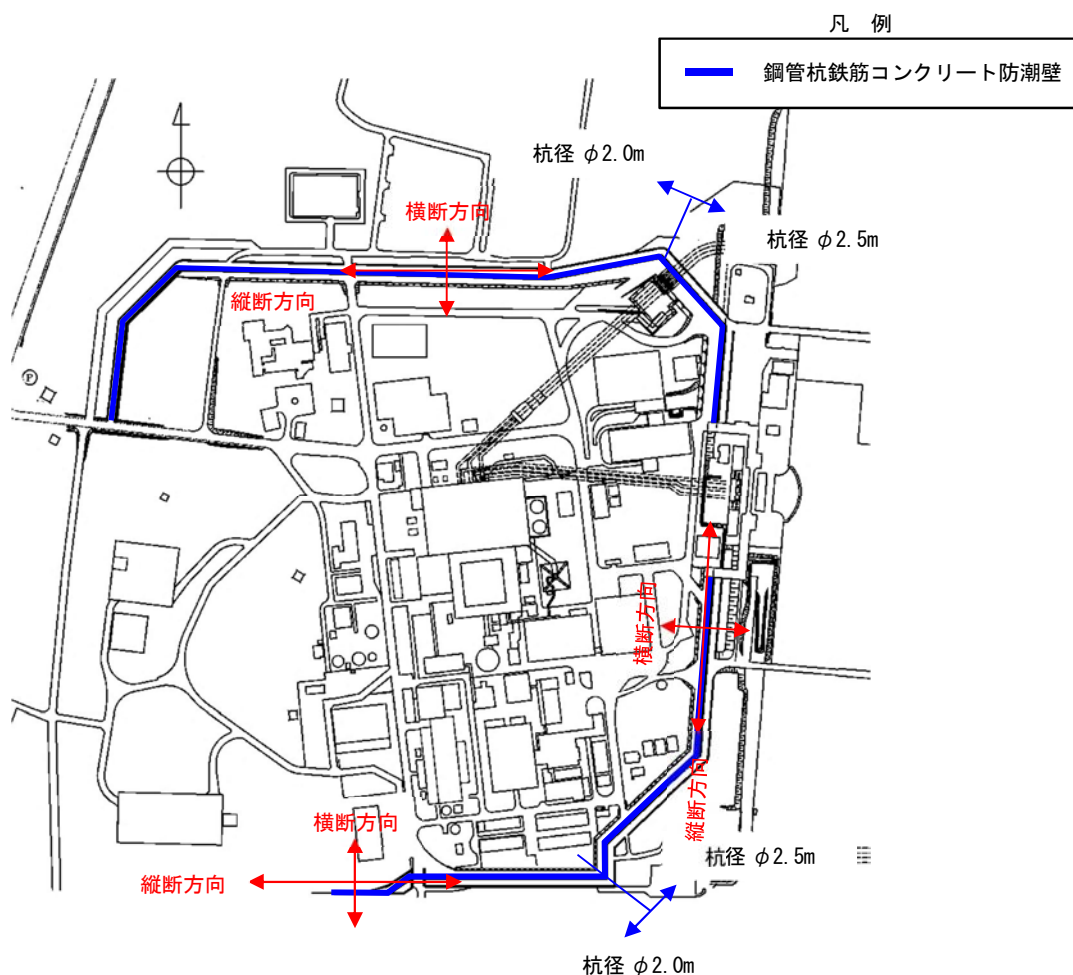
鋼管杭鉄筋コンクリート防潮壁の平面配置図
